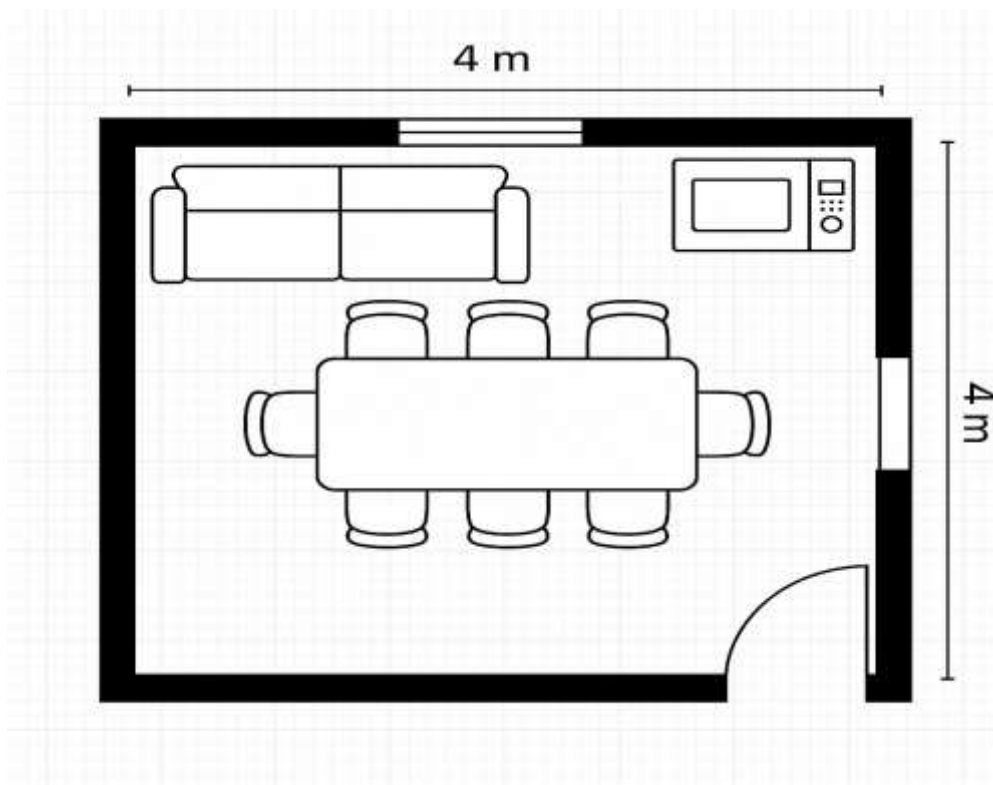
Plano Zona de Descanso Nota: Elaboración Propia
